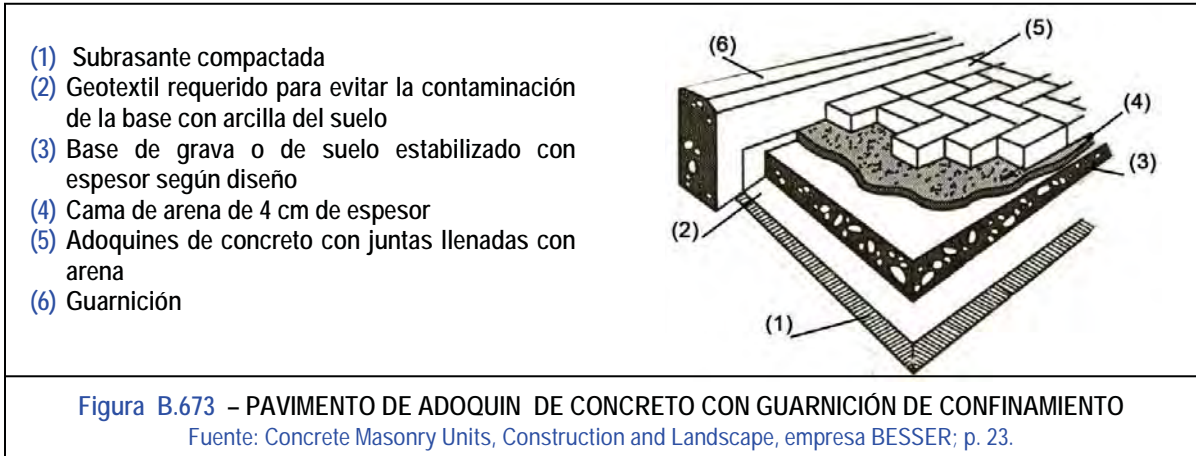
PAVIMENTO DE ADOQUIN DE CONCRETO CON GUARNICIÓN DE CONFINAMIENTO
